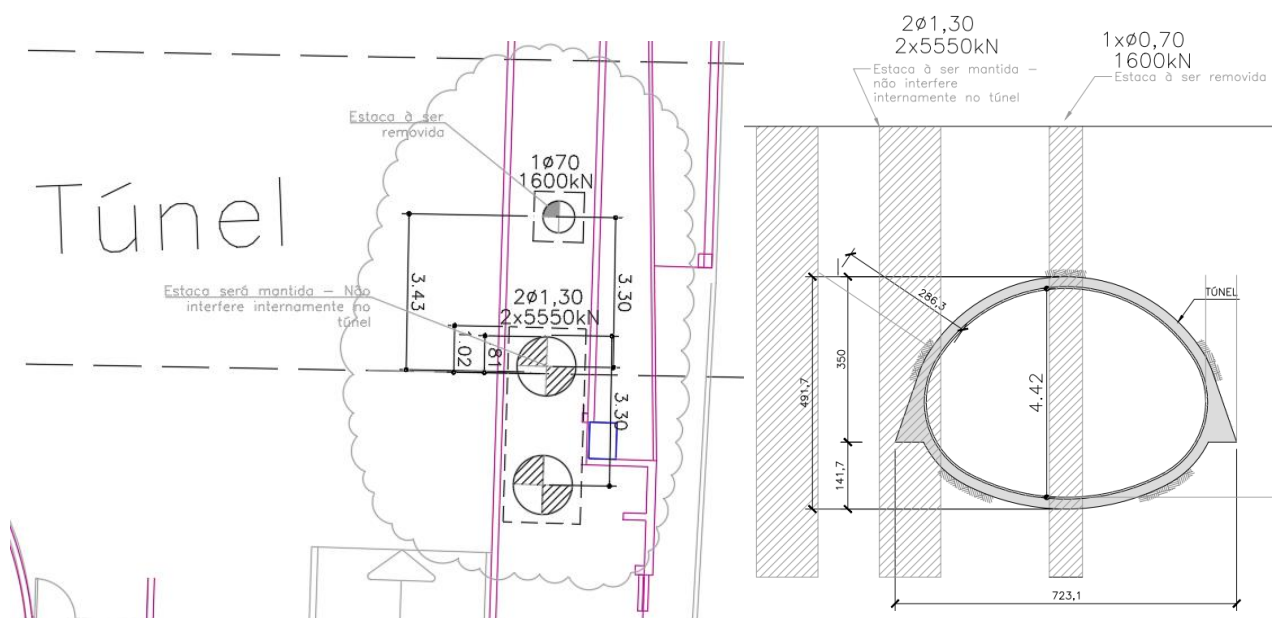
Planta e seção de interferência com estacas de fundação conforme projeto inicial.
